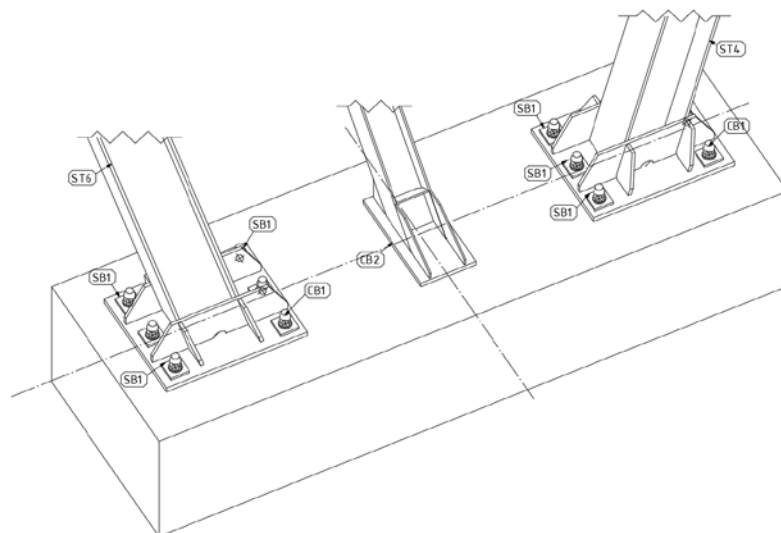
Detaliu conexiune stâlp metalic-fundație beton armat
